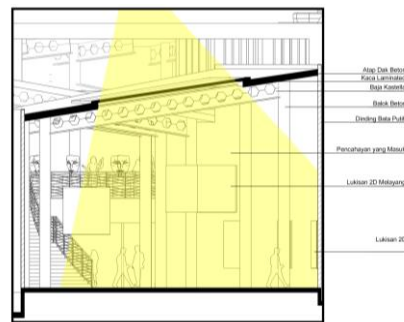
6. Sirkulasi dalam bangunan lantai 2
